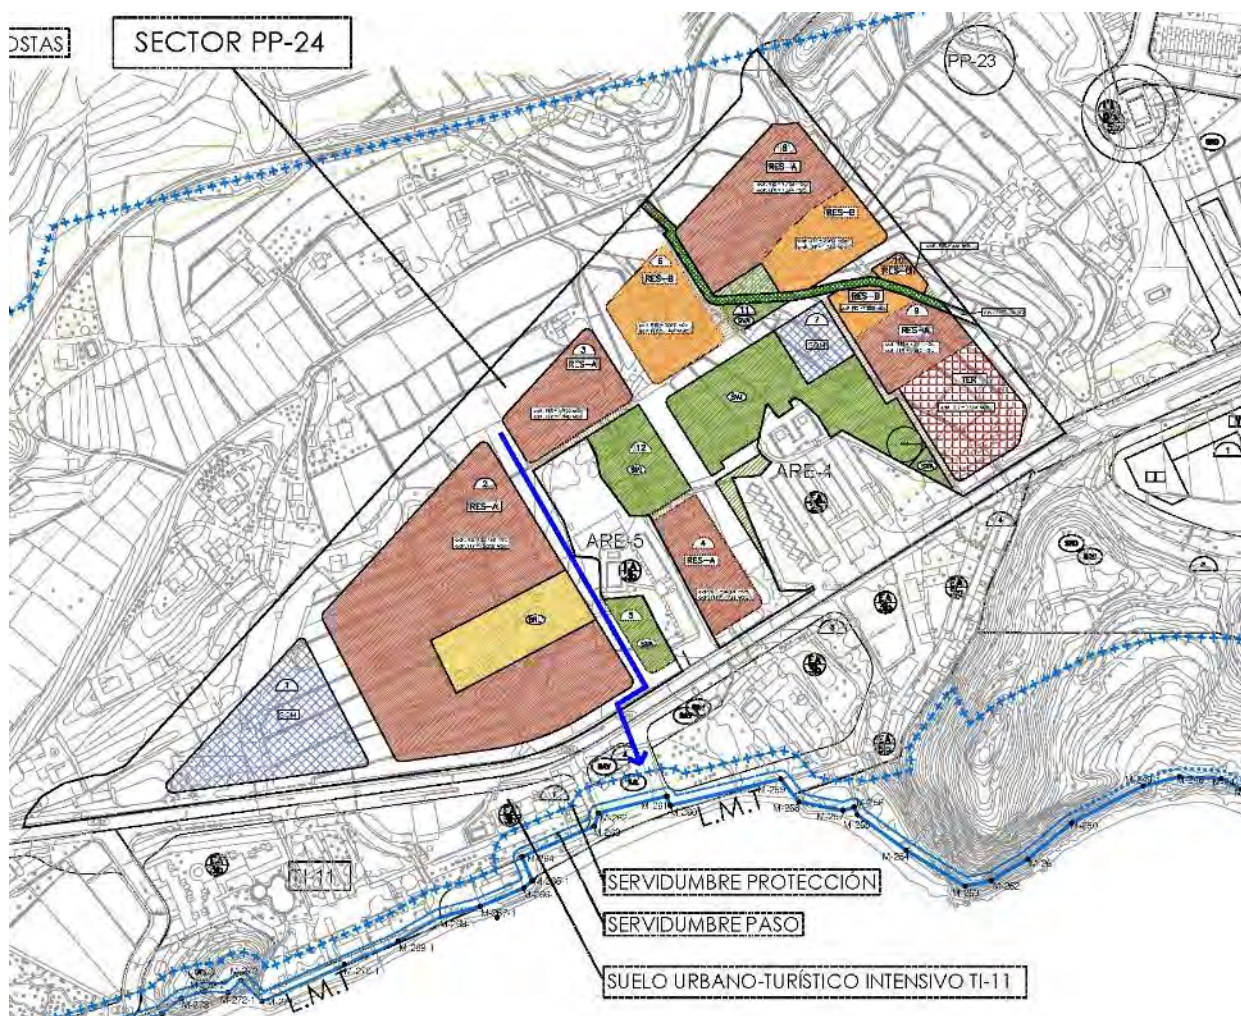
Plano del sector PP-24 y trazo de la obra de drenaje en azul
